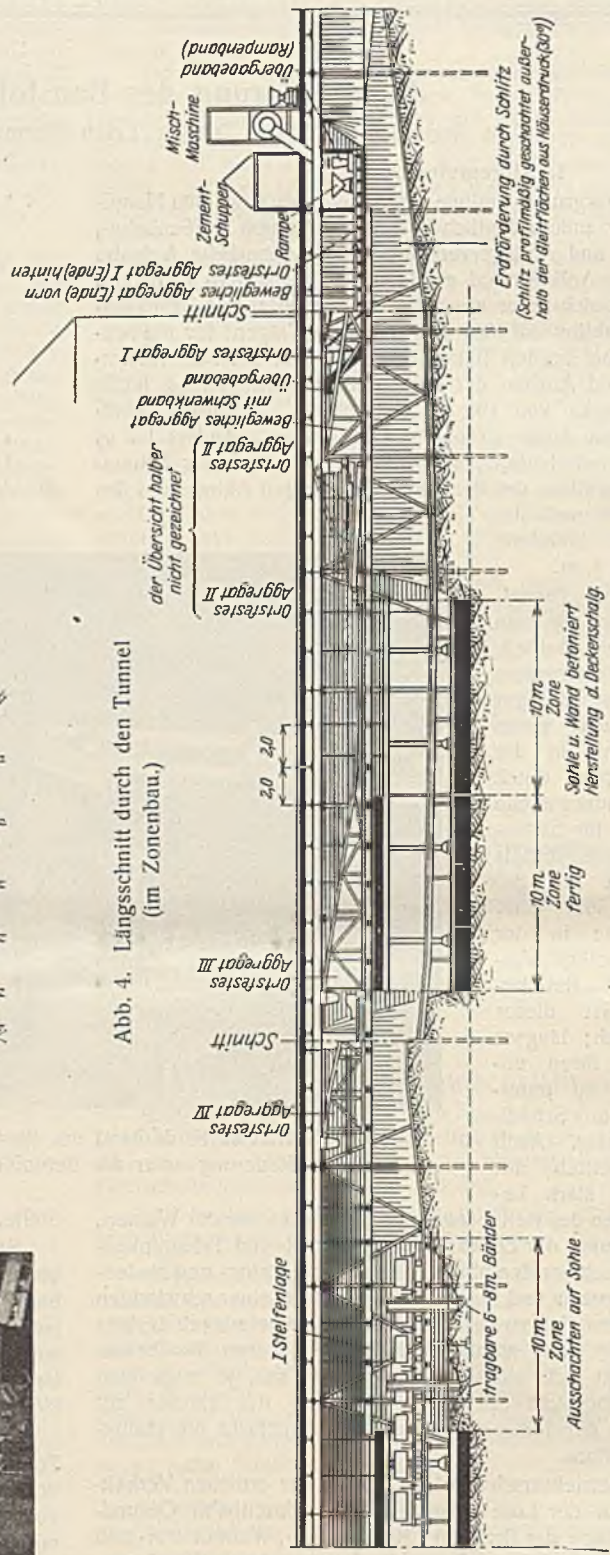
Längsschnitt durch den Tunnel (im Zonenbau.)
